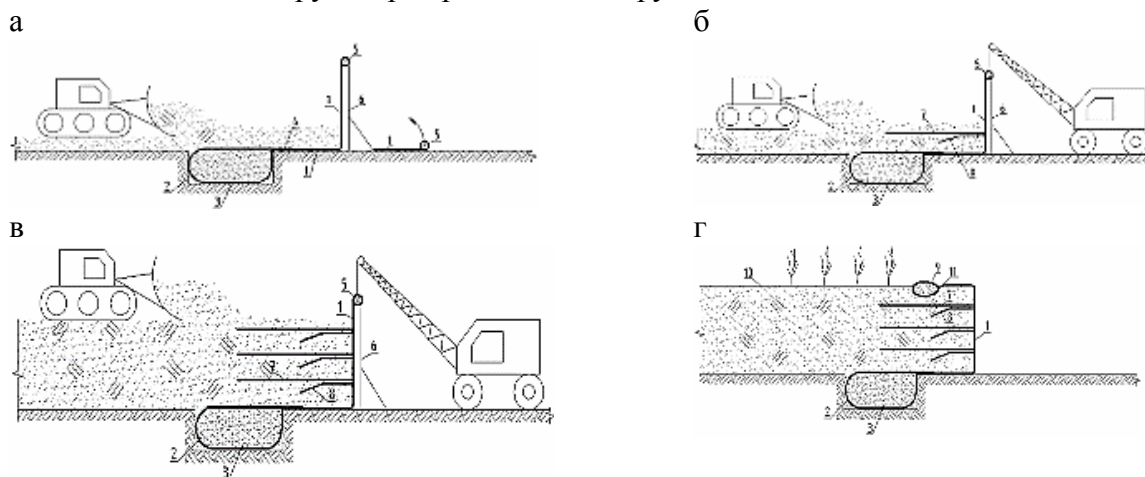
Устройство удерживающей (подпорной) конструкции для создания основания на техногенных грунтах (а - устройство грунтонаполняемого анкера и поддерживающего устройства; б- укладка грунта и первого ряда арматуры; в- послойное уплотнение и засыпка армированной насыпи; г – конструкция после возведения 1 – единая лицевая стенка; 2 – оболочка грунтонаполняемого анкера; 3 – наполнитель грунтонаполняемого анкера; 4 – узел крепления; 5 – барабан для намотки единого полотна; 6 – подпорное устройство; 7 – прямолинейная армолента; 8 – наклонная армолента; 9 – верхний грунтонаполняемый анкер; 10 – полимерный материал с семенами растений, например, «Пинема-500С»; 11 – ливнеотводящее устройство).
